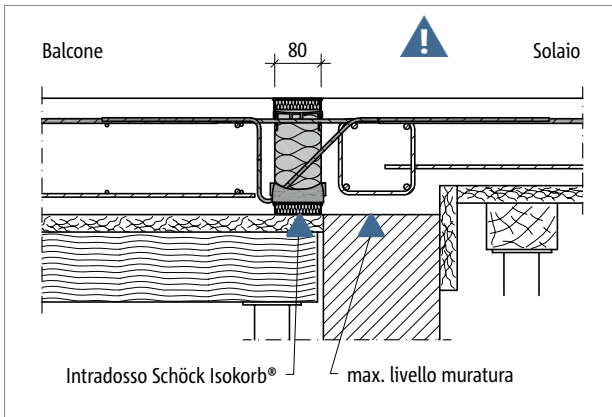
Schöck Isokorb® T tipo K: balcone in opera dotato di solaio con dislivello su parete in muratura
